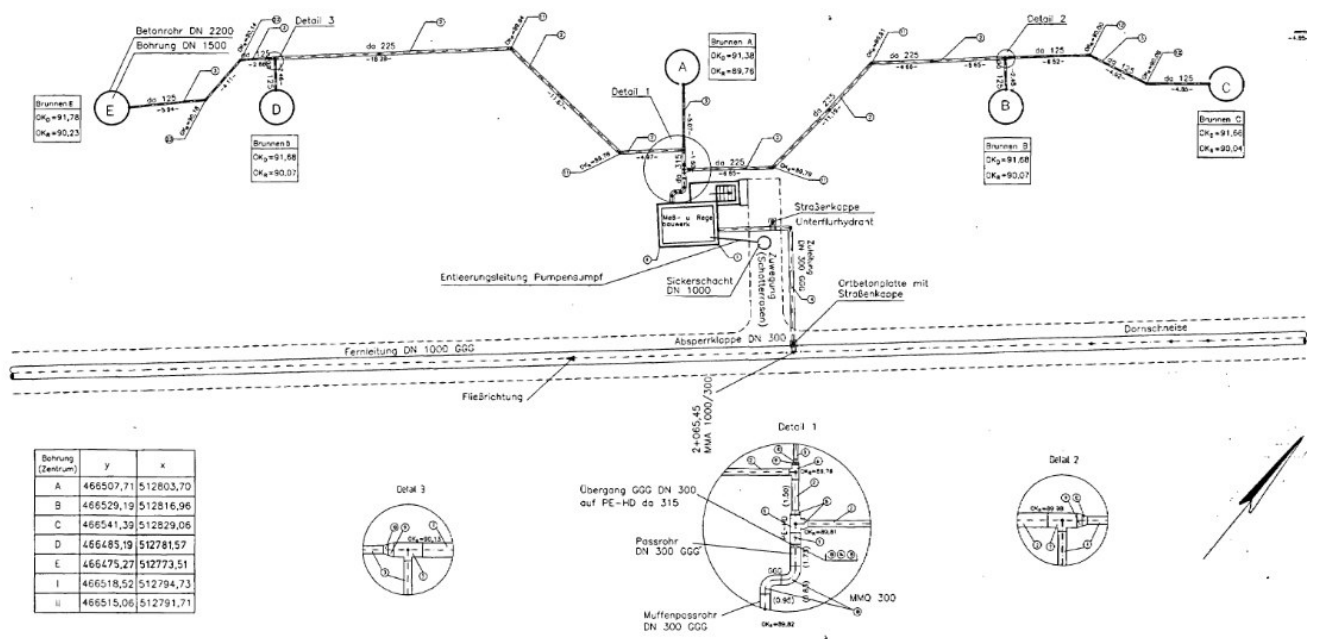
Lageplan des Infiltrationsorgans 4 im Gernsheimer Wald
